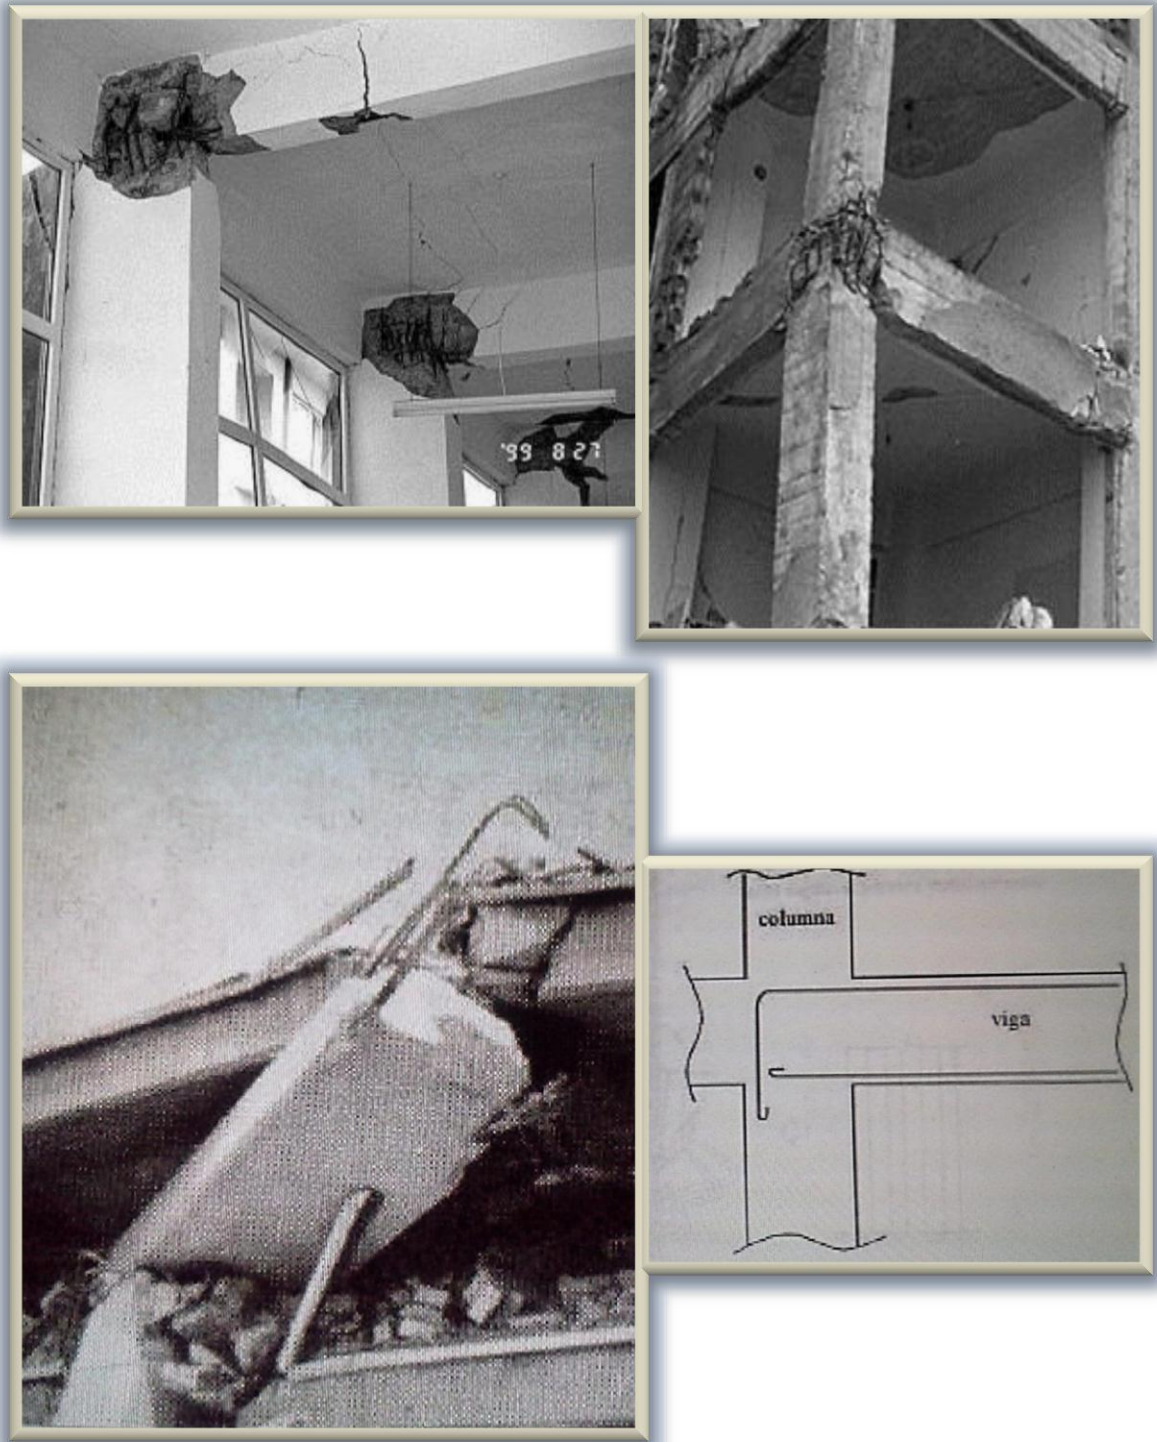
c.2-2) Otros ejemplos de fallas en conexiones viga-columna. Arriba, falla de adherencia y pandeo de barras por flexión. Abajo, articulación en unión con el sistema de piso por escasez de anclaje, a su vez origina falla por flexocompresión en columna; al lado, croquis muestra un anclaje correcto
